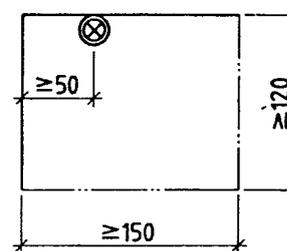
Bewegungsfläche neben Bedienungsvorrichtungen
